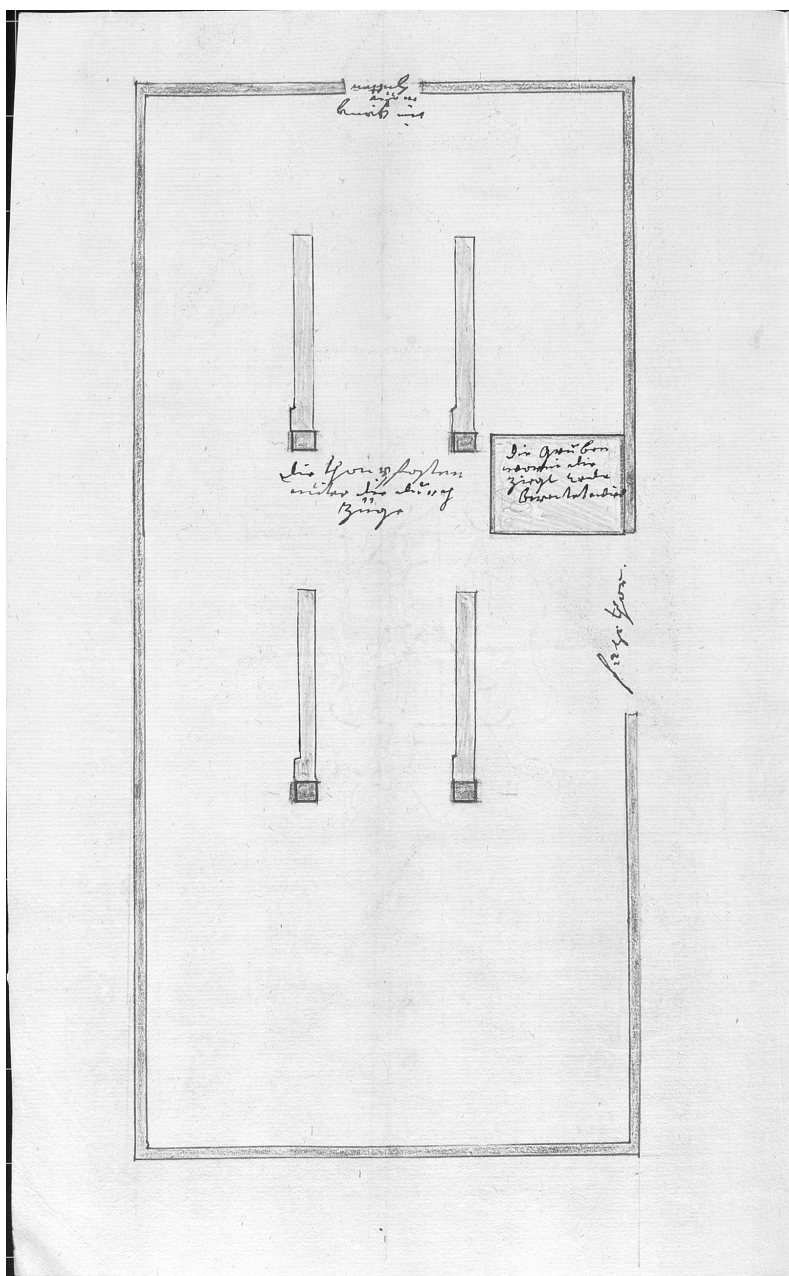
Grundriss der Einartsbäuser Ziegelhütte
